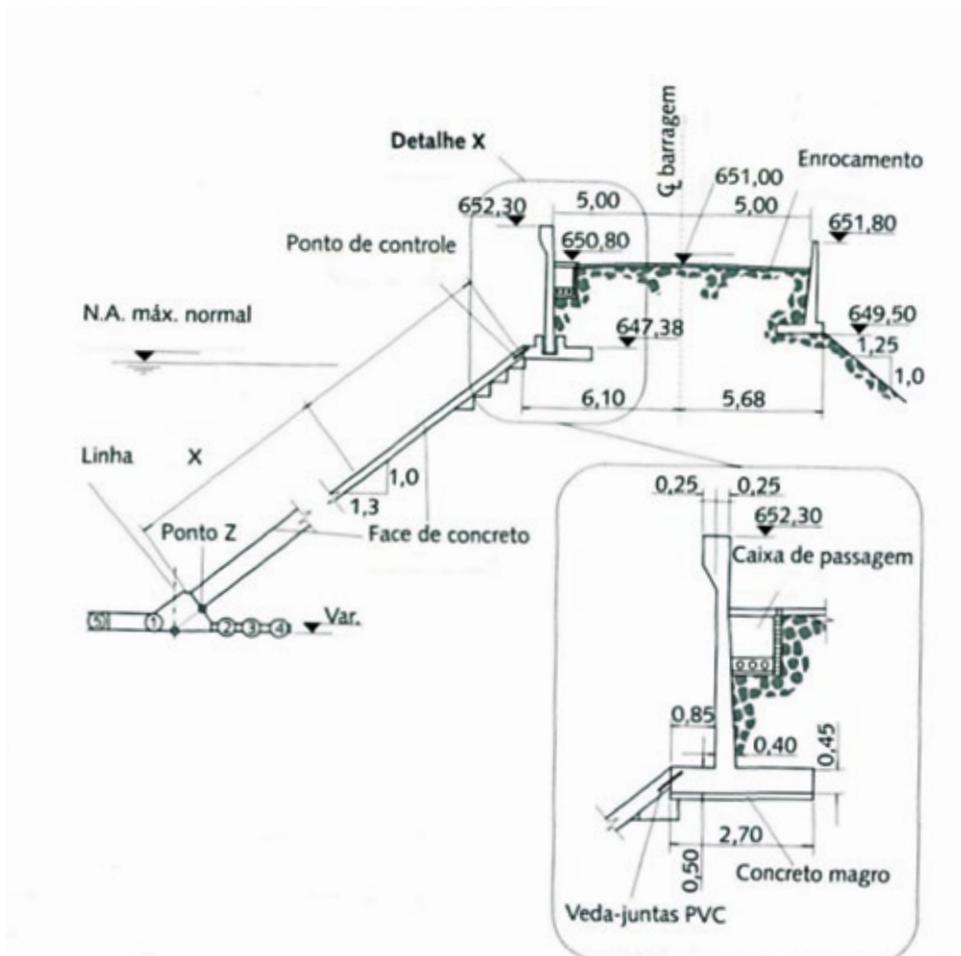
Detalhe do muro da crista e da junta de expansão no contato laje-fundação do muro da barragem de Barra Grande, RS/SC.
